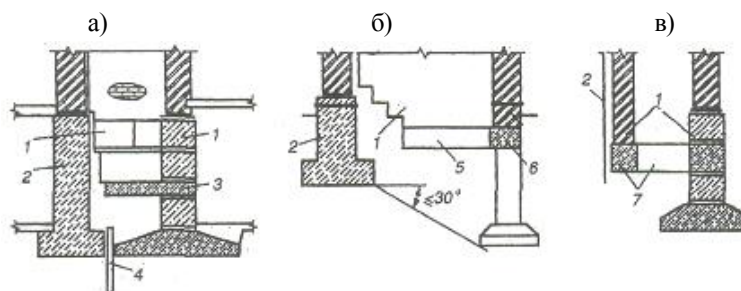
Примыкание фундаментов пристроек к существующим зданиям: *а* – с заложением подошвы на уровне существующего фундамента; *б* – то же, с заглублением; *в* – то же, но стены примыкания опираются на консольную конструкцию; 1 – новый фундамент; 2 – то же, старый; 3 – консольная железобетонная плита; 4 – шпунтовый ряд; 5 – консольная балка; 6 – балка обвязки; 7 – консольная конструкция по контуру стен
